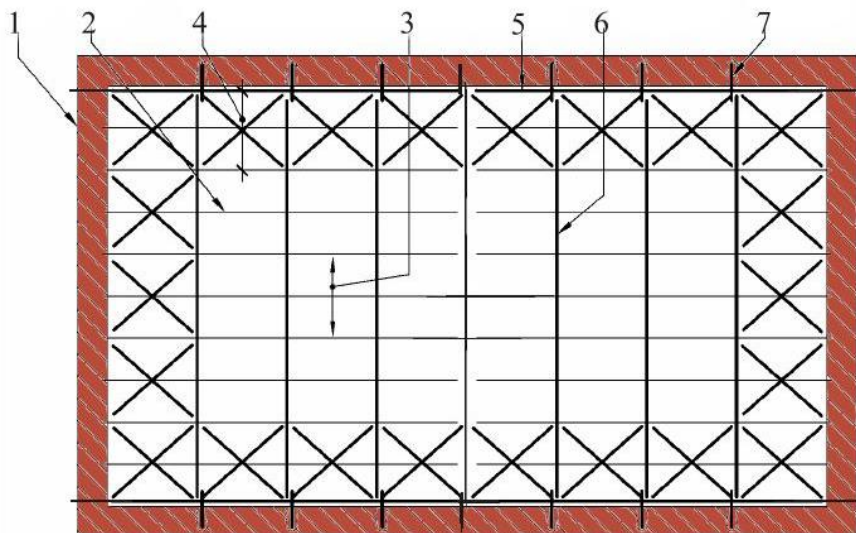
Consolidarea planșelor boltișoare de cărămidă (după FEMA 547, p. 22-37):
